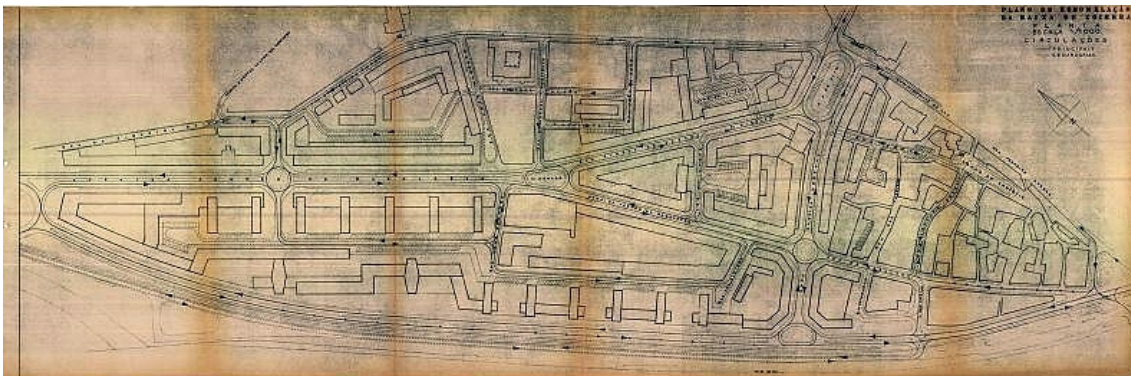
1956 A – Plano de Remodelação da Baixa de Coimbra, de Alberto José Pessoa;
